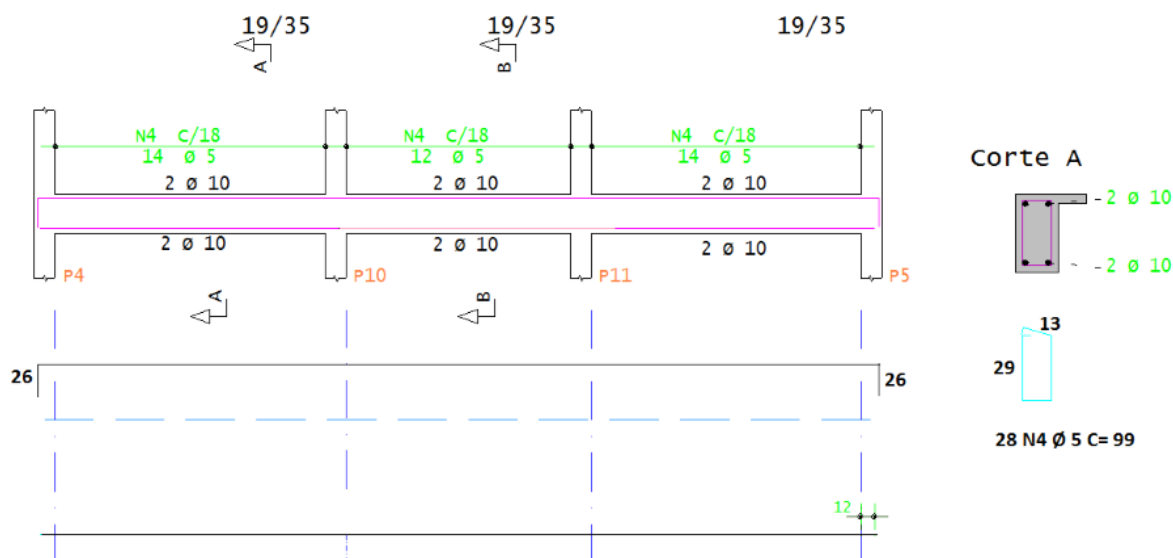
Detalhamento da viga V3. Fonte: autores.
